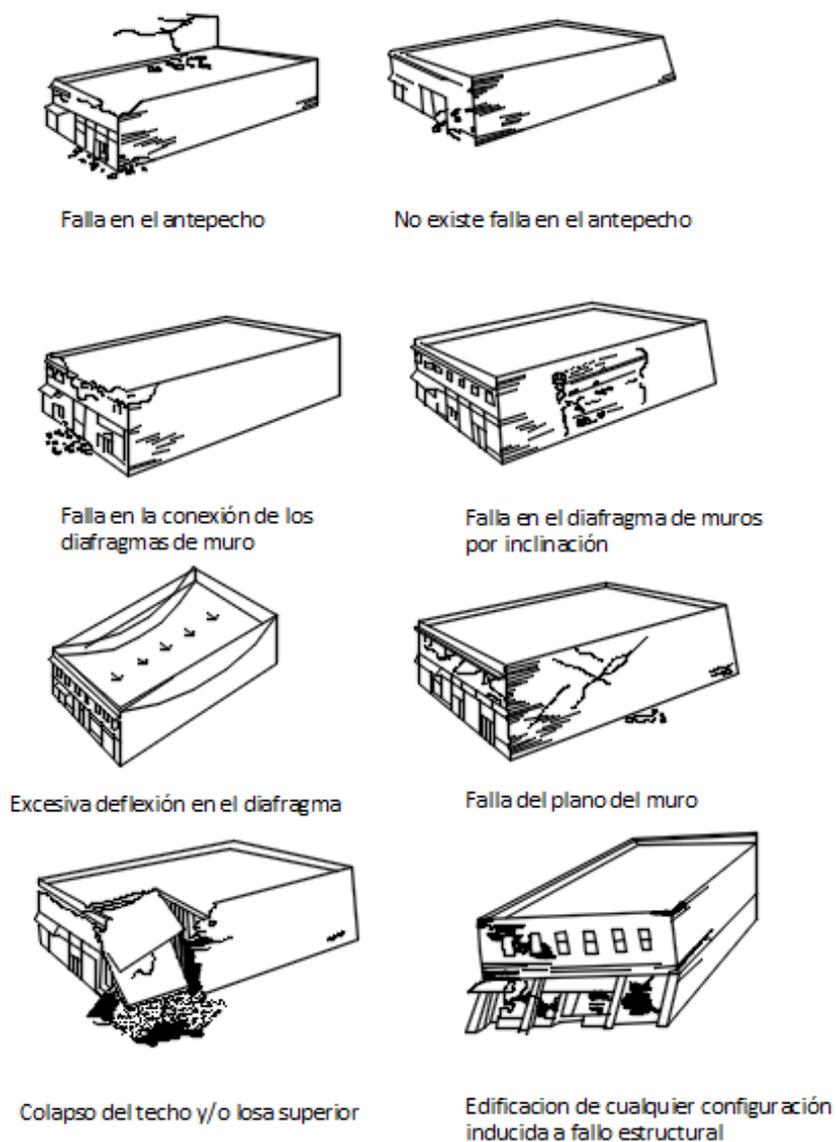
Tipos de fallas estructurales provocadas por terremotos en edificaciones de mampostería sin refuerzo estructural.
